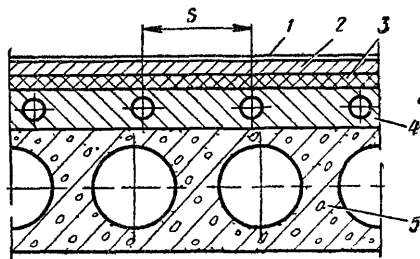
Размещение бетонной отопительной панели в перекрытии со сборным несущим настилом
